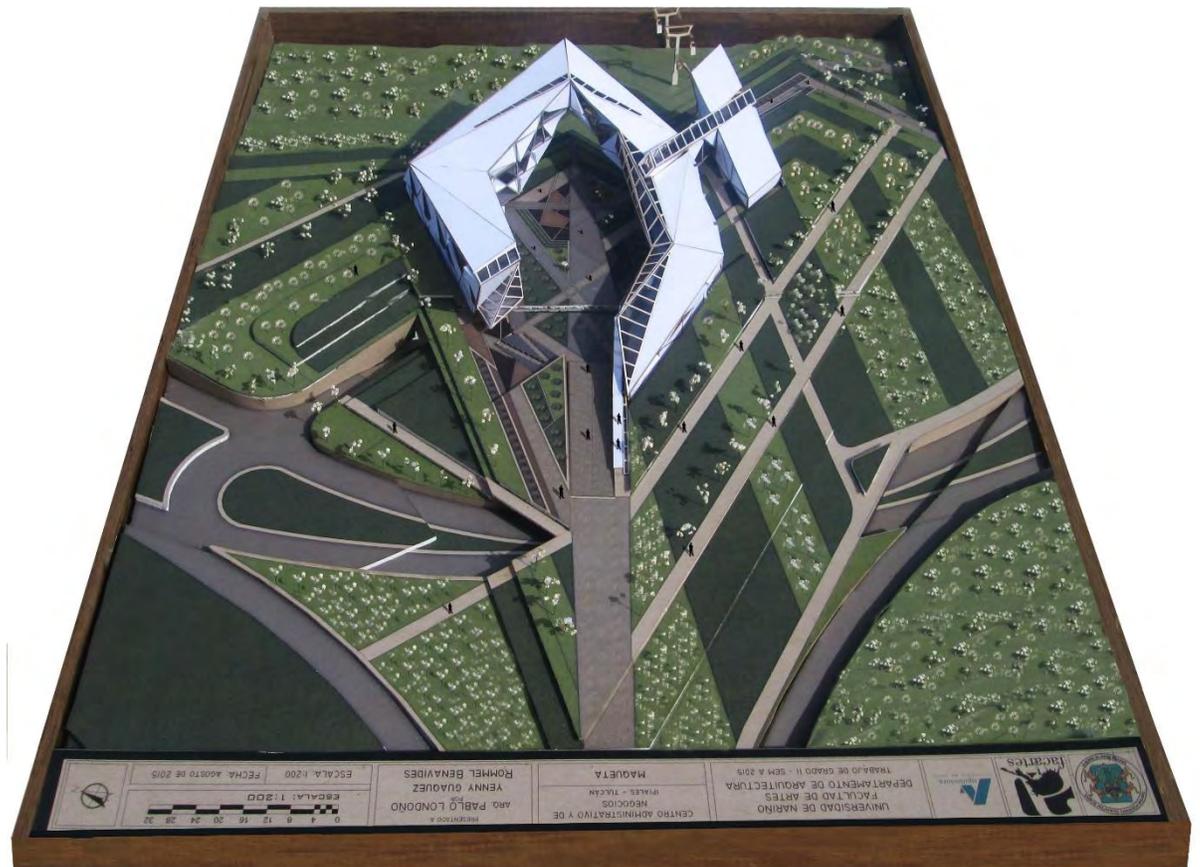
Fotografía de maqueta final vista sur. Fuente: Elaboración propia
